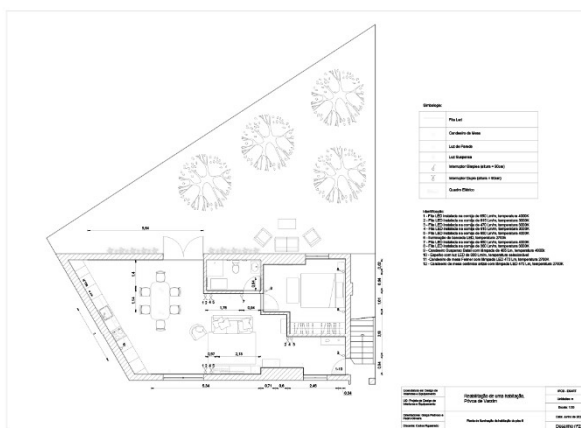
Planta de Iluminação Habitação Piso 0. Fonte: Autor.
